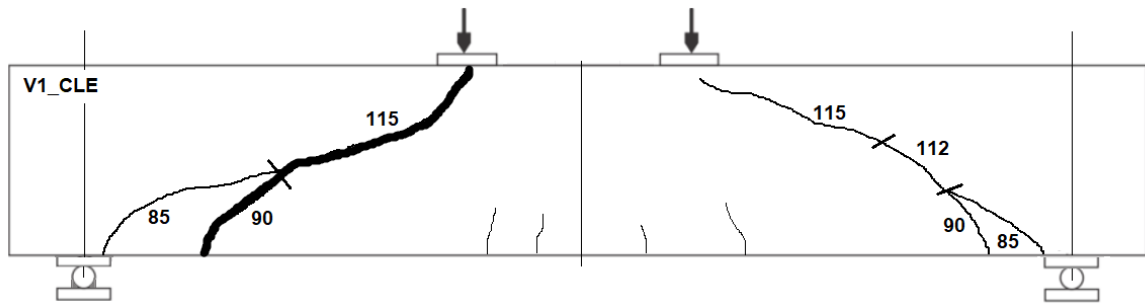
Esquema de fissuração da Viga 1_CLE.
